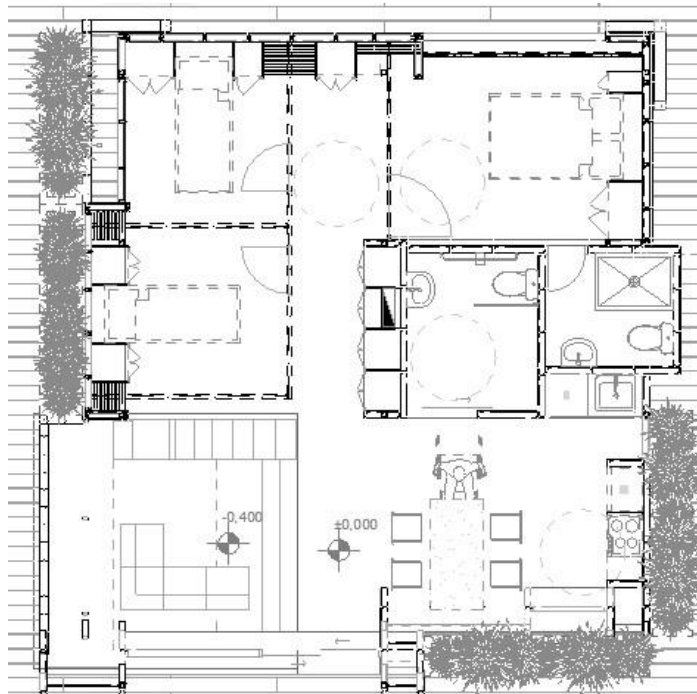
planta baja proyecto LAR. Diseño propio. Archicad
